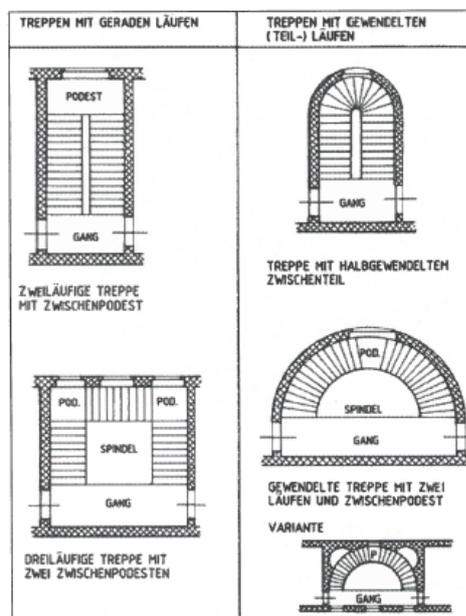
Bauformen - Grundrisse typischer Treppenhäuser der Gründerzeit²⁸
